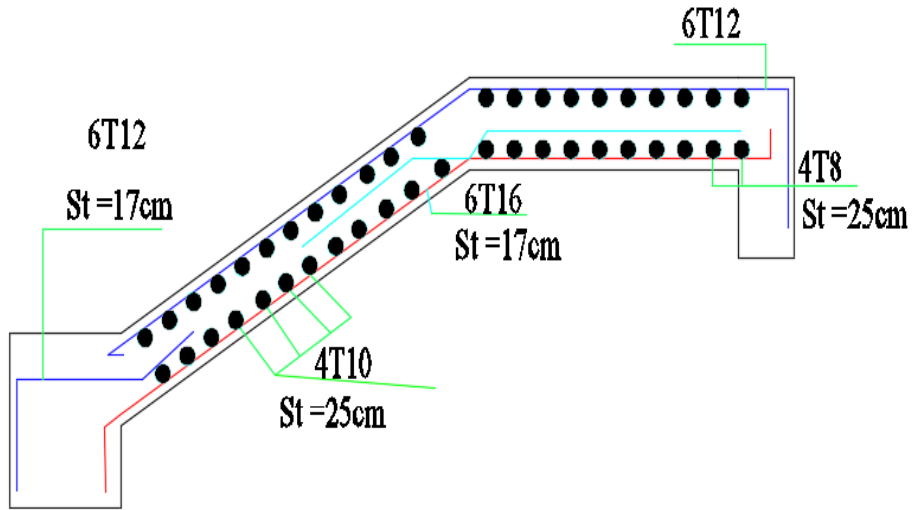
ferrailage de 1^{er} volée de l'escalier de entre sol
